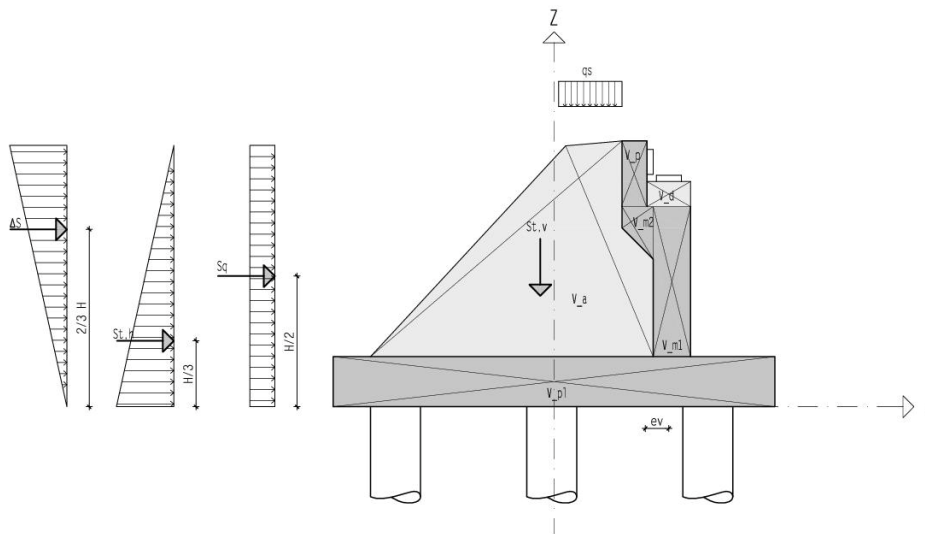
Sezione della spalla con indicazioni sui carichi
